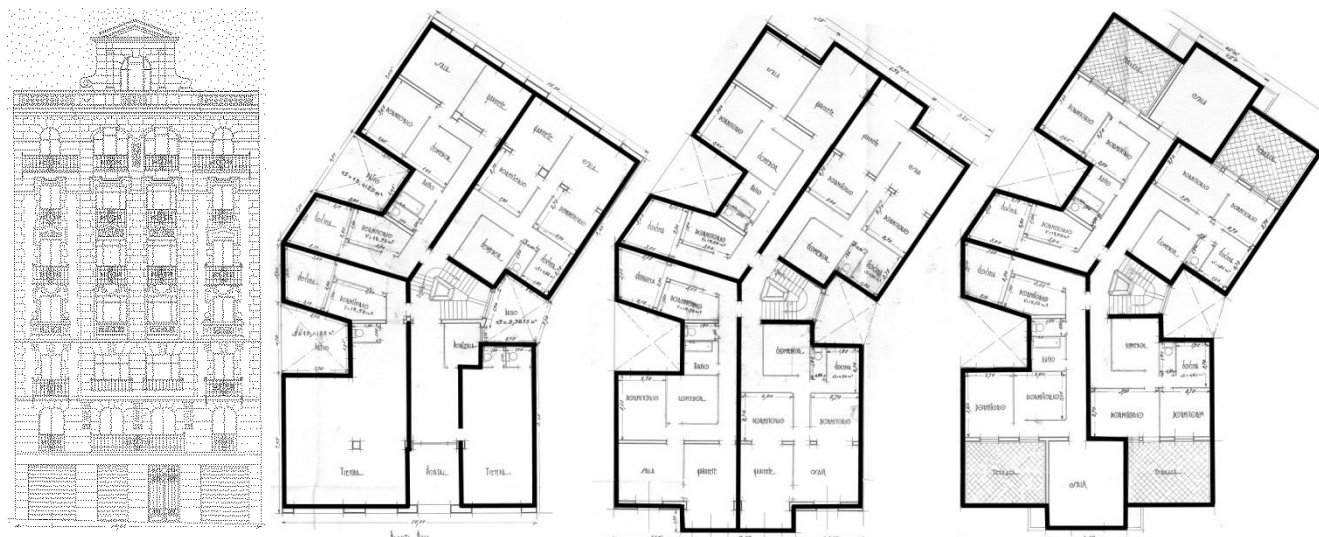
Fachada y planos de las plantas baja, principal y ático presentados por Luis Olasagasti Medina en el nº 108 de la calle Alcalá (luego 106). Escala 1:100. AVM, Secretaría, 25-260-3. 1926-1928.
